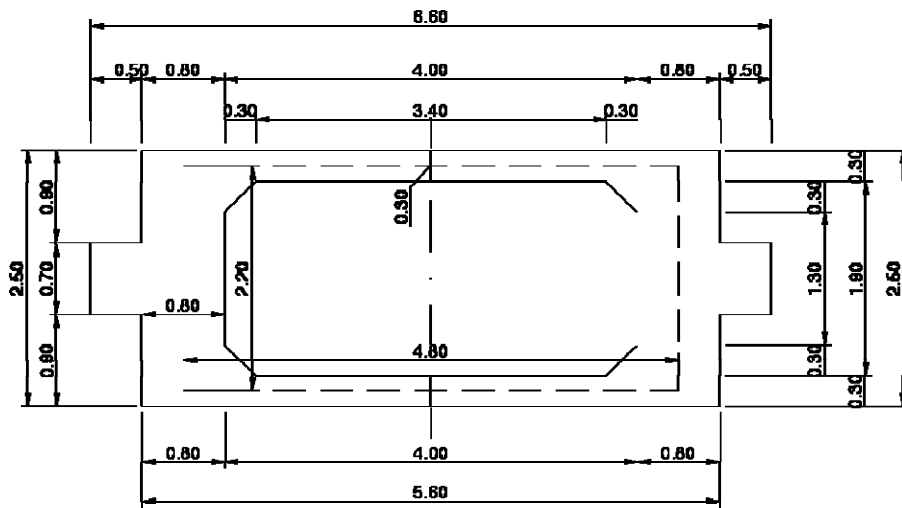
Carpenteria della sezione 2 delle pile;
